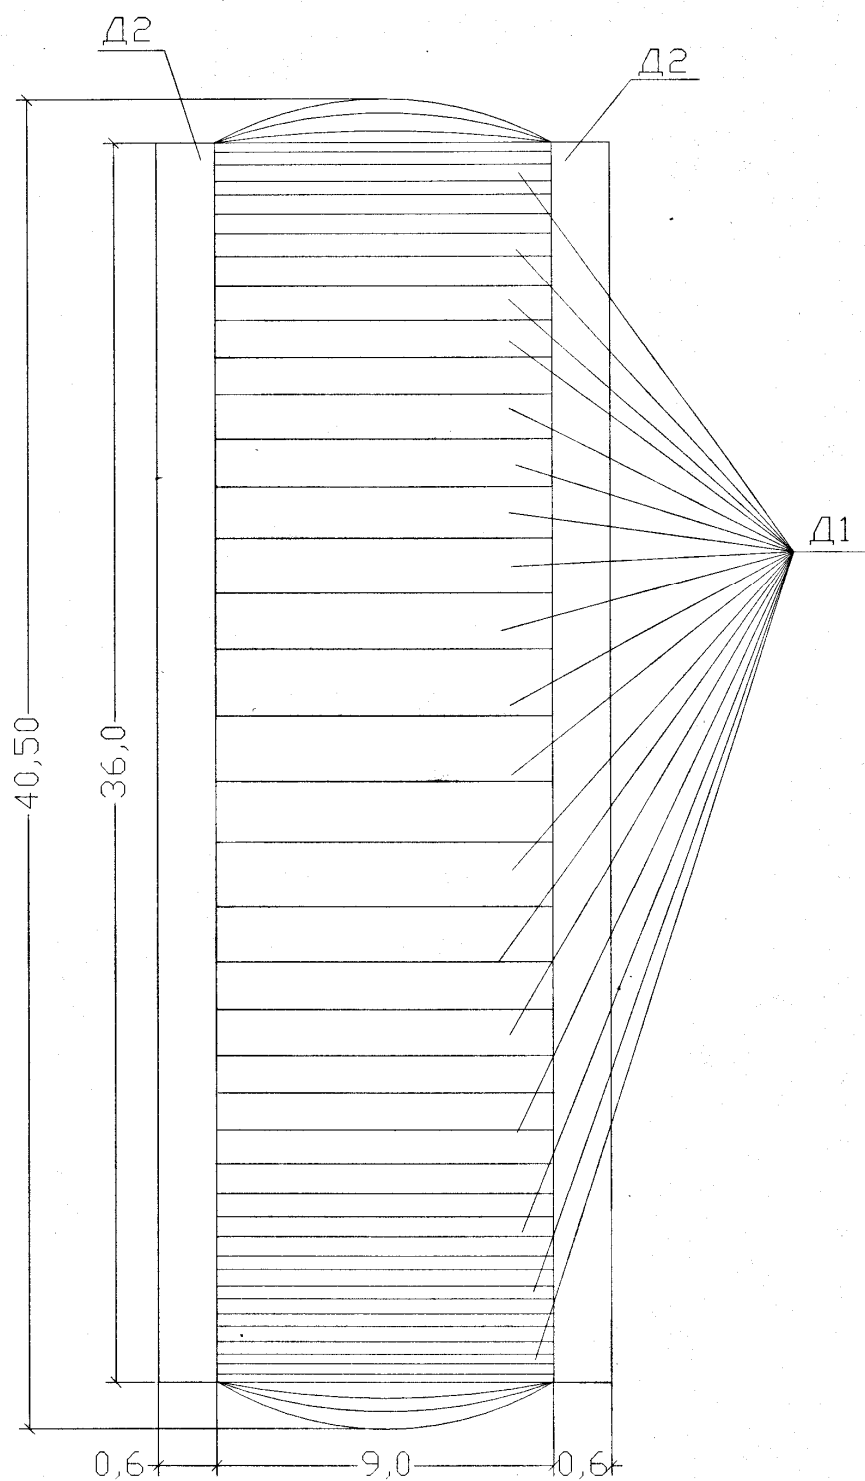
ОВЦ-36. Элемент Эр-4. Детализовка
